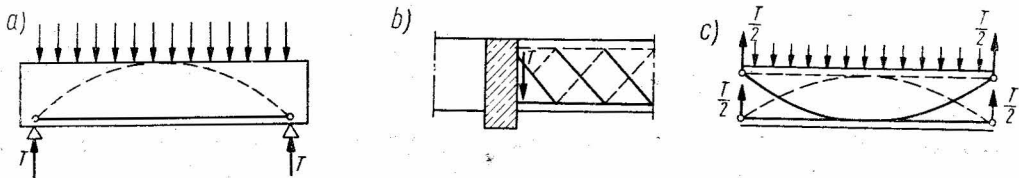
Schéma de la poutre en béton armé d'après RAUSCH : a) poutre simplement appuyée, b) poutre encastrée dans une poutre-maîtresse, c) poutre appuyée sur toute sa hauteur
